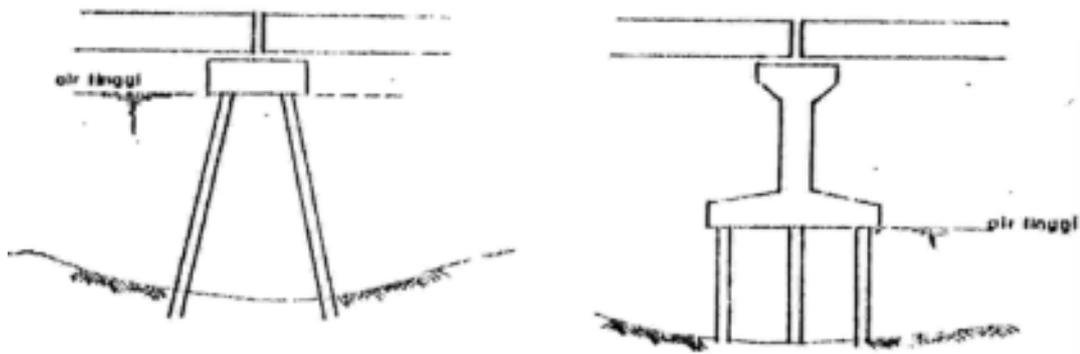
Pilar dengan Bentuk Kolom Bulat
